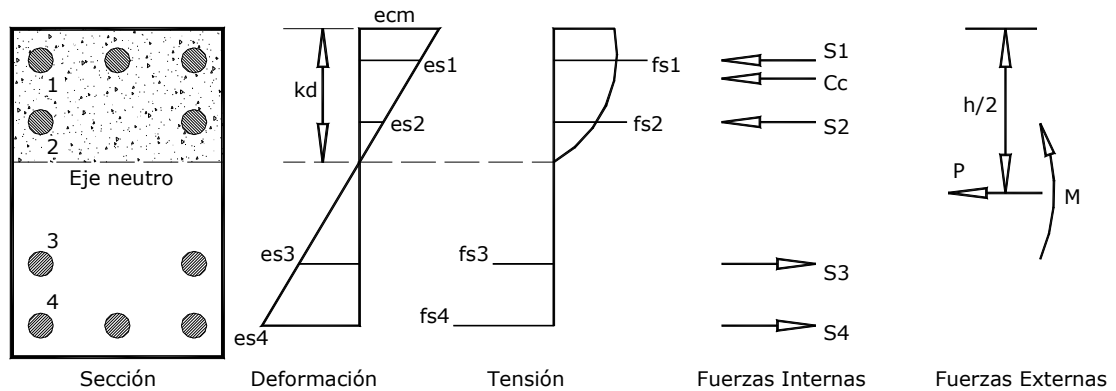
Tensión y deformación en una sección transversal de hormigón
